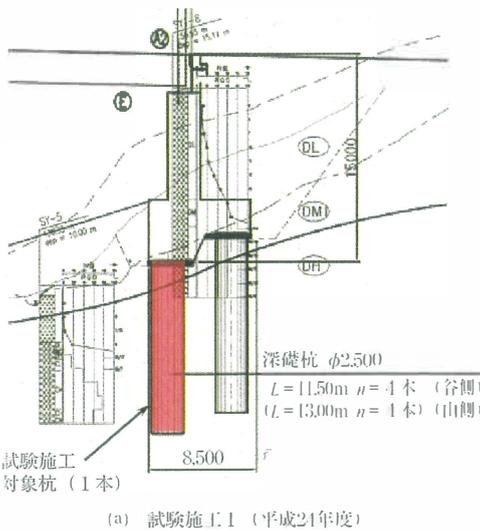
小口径深礎杭孔内無人化施工システムの試験施工
